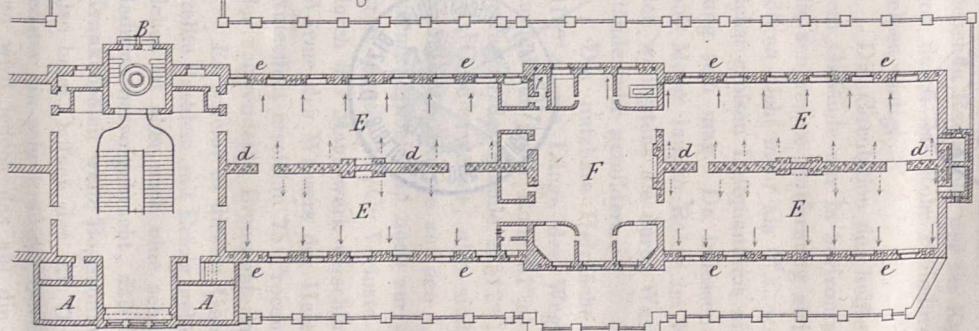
Grundriss des Kellergeschosses nach C.D., Fig. 8, mit dem Heizungs-Apparat.
